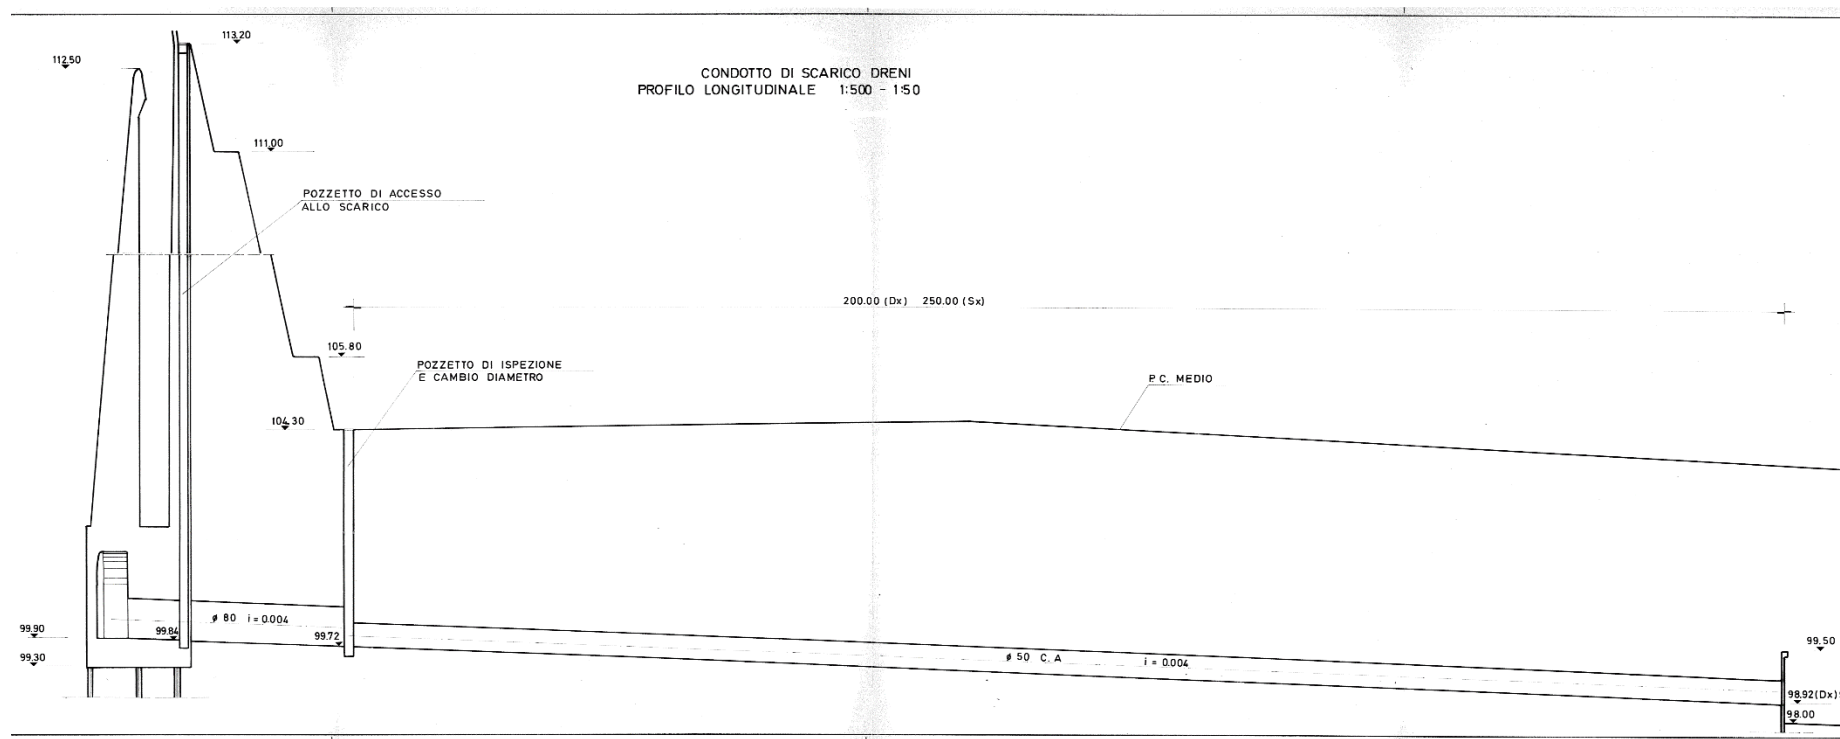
allegato 32 – Profilo longitudinale linea di scarico
